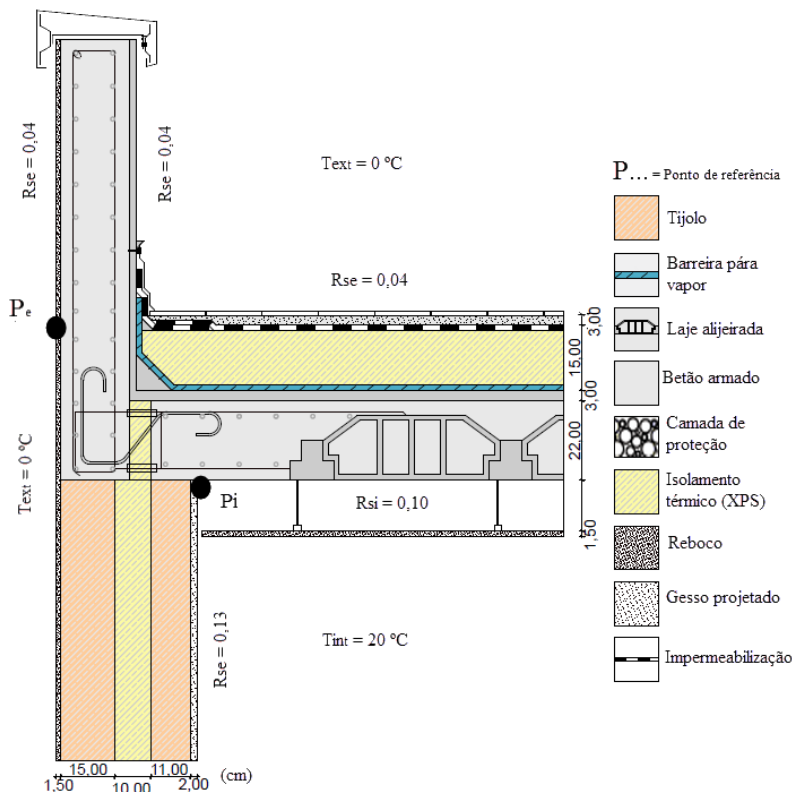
Ligação de fachada (parede dupla) com terraço (com platibanda)
